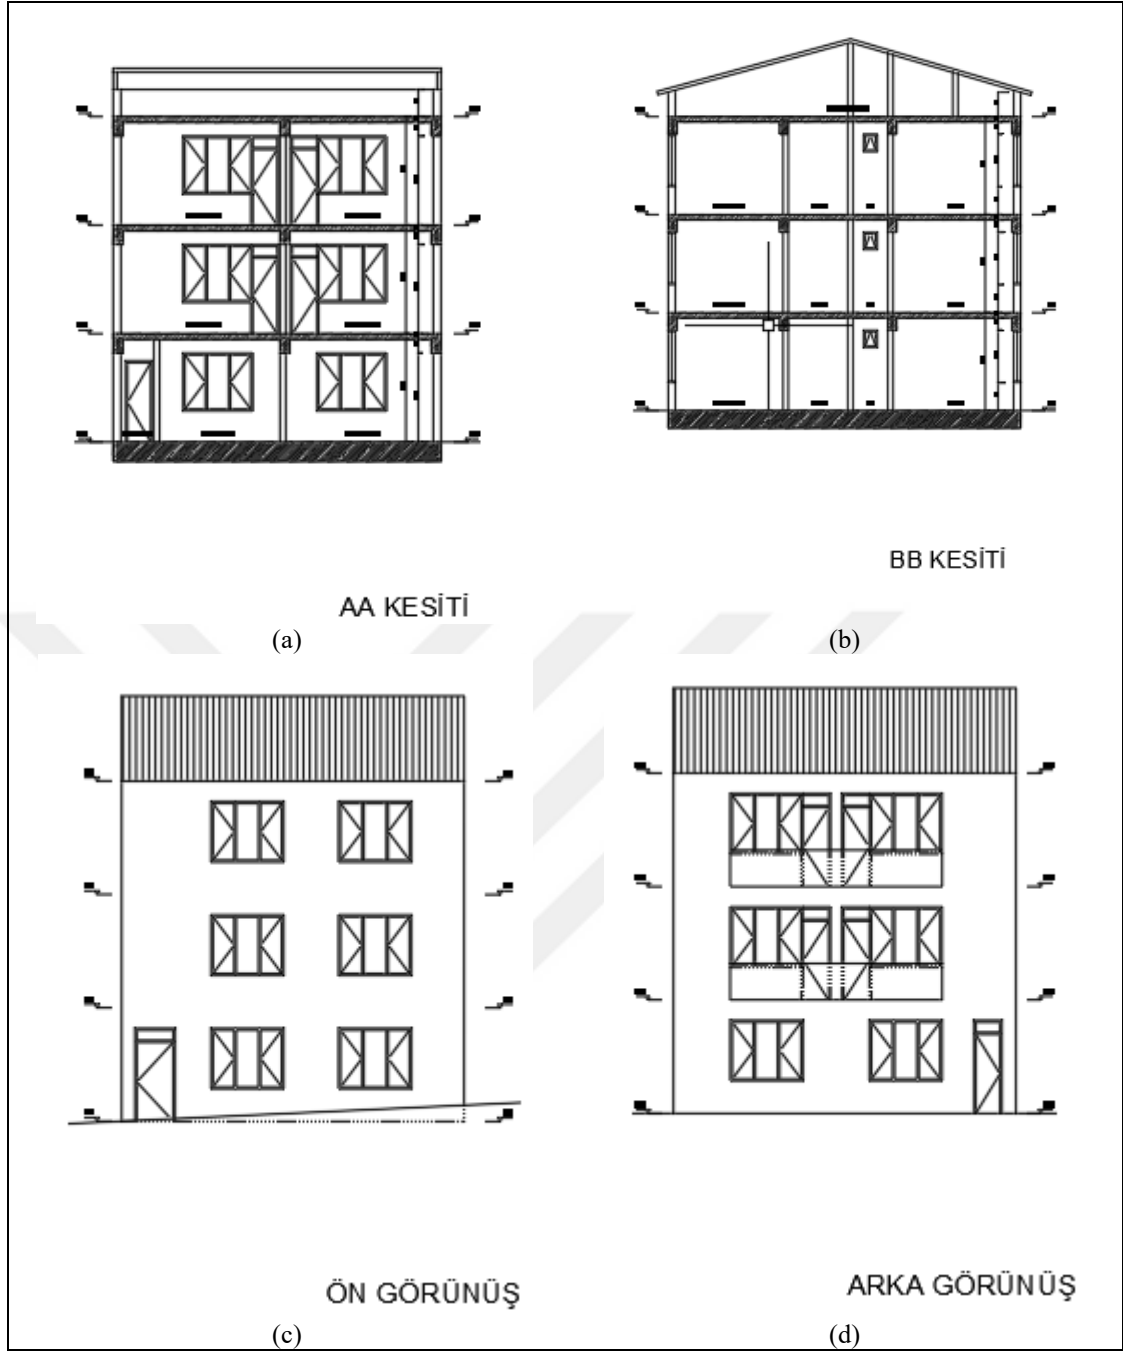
’de binanın kesit görünüş planları verilmiştir.
